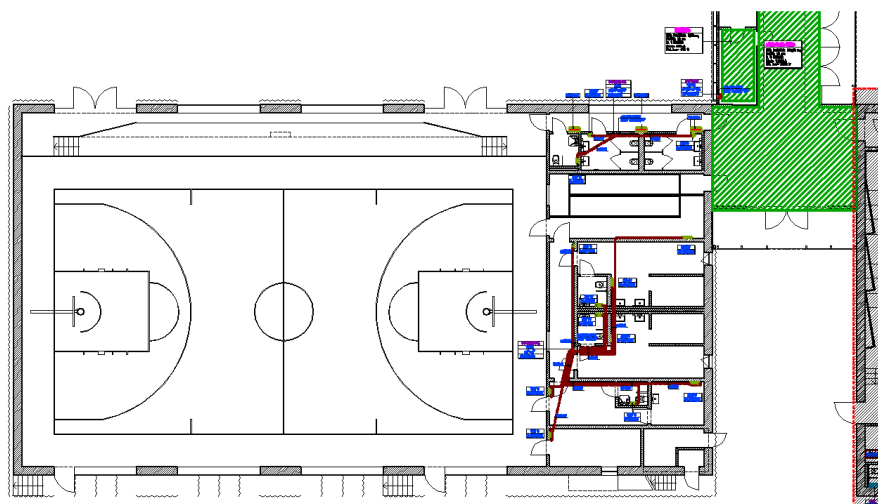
Pianta piano primo scuola: impianto termico in progetto
